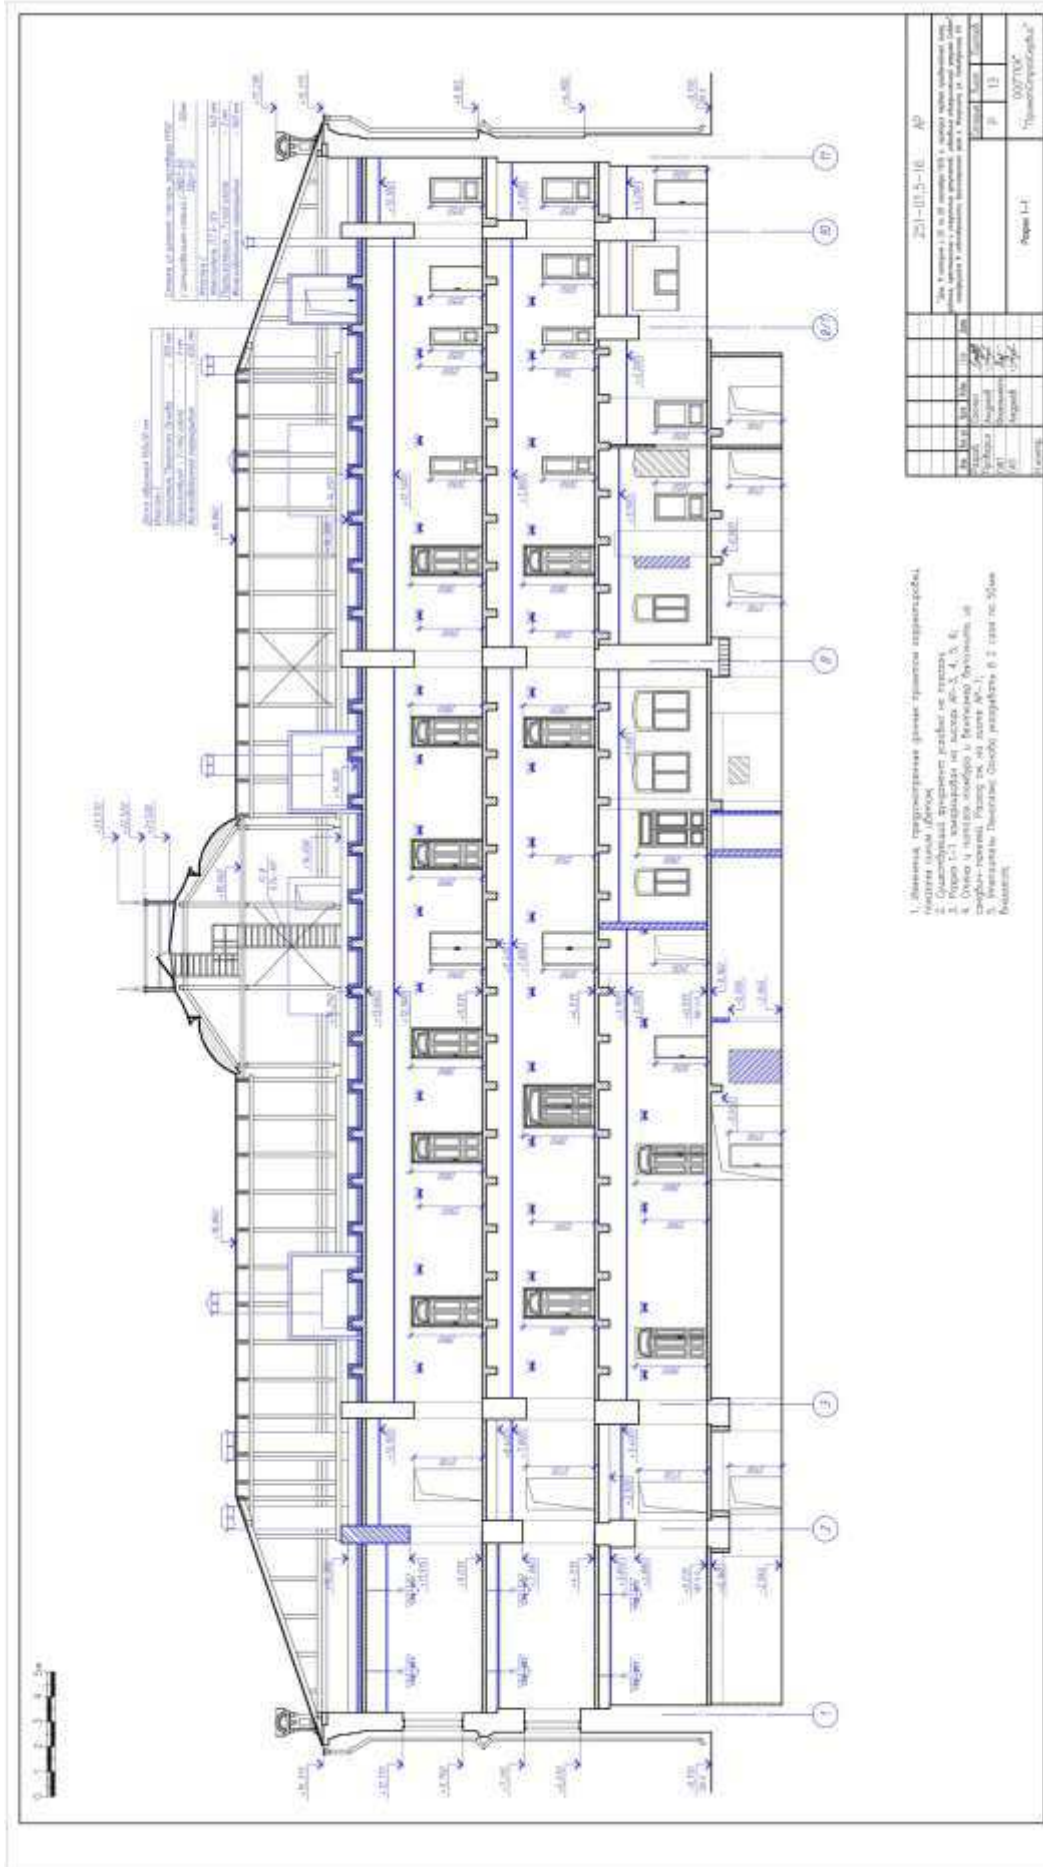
План реконструкции дома Вильнера разрез 2-2
